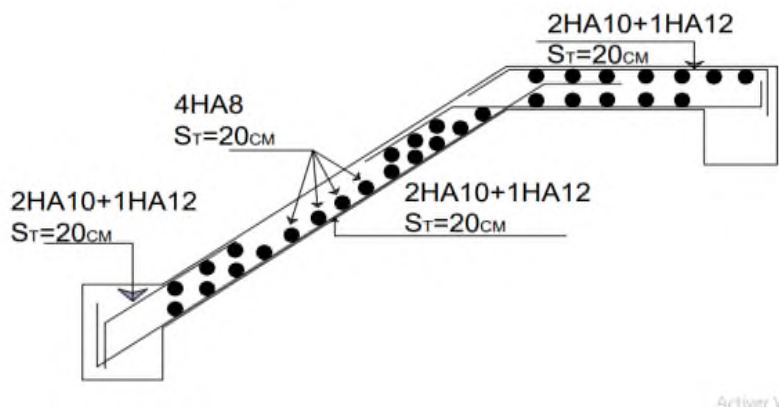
Schéma de ferrailage l'escalier de type 1
